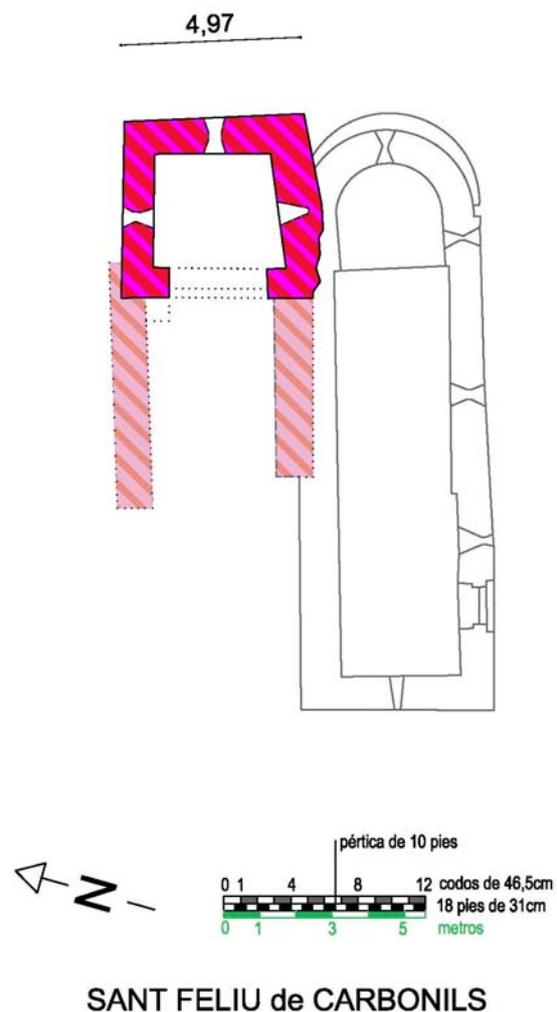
Planta crono-cromática de St. Feliu. Elaborada por autora.
